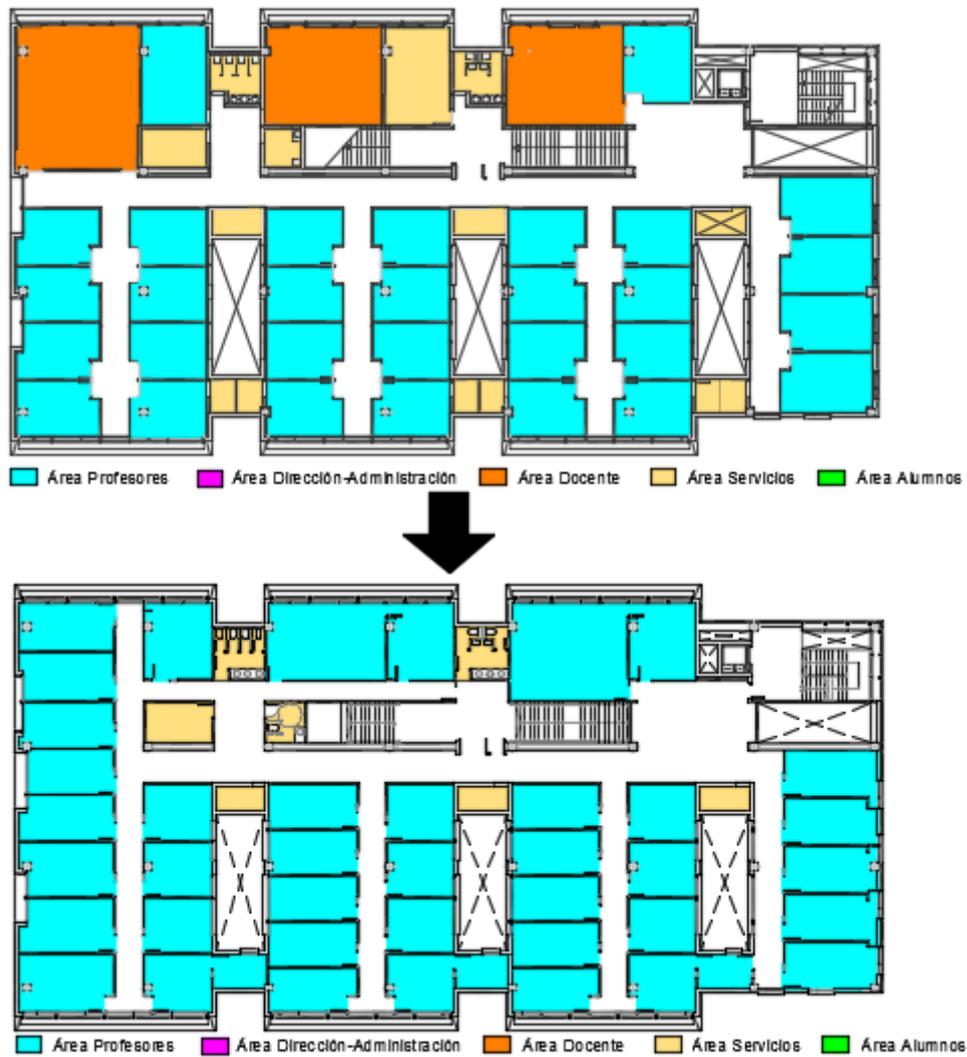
Comparación estado actual-propuesta Planta Segunda. Figura extraída del plano 38 y 54.
